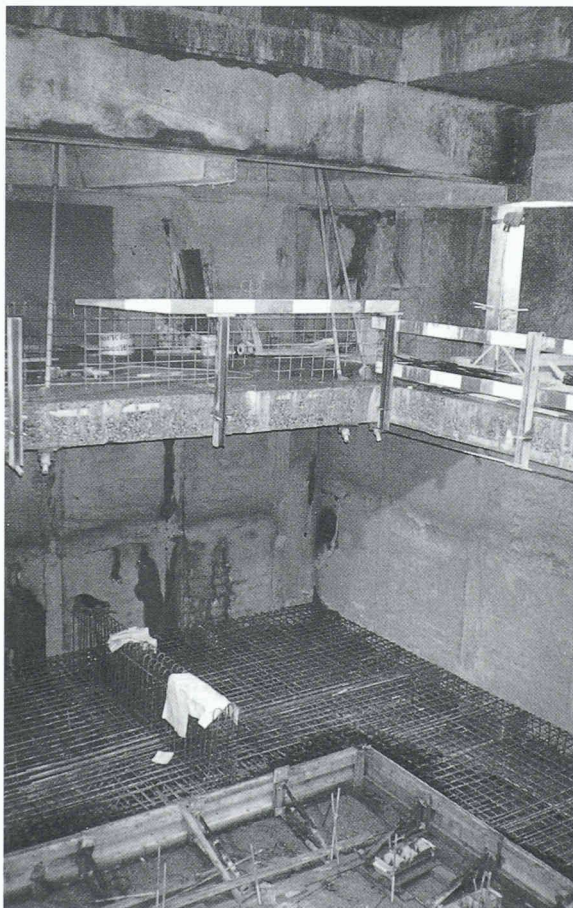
Puits de Chauderon: ferrailage de la dalle du niveau -2; on y distingue également les barres de suspension de la dalle du niveau -1.
